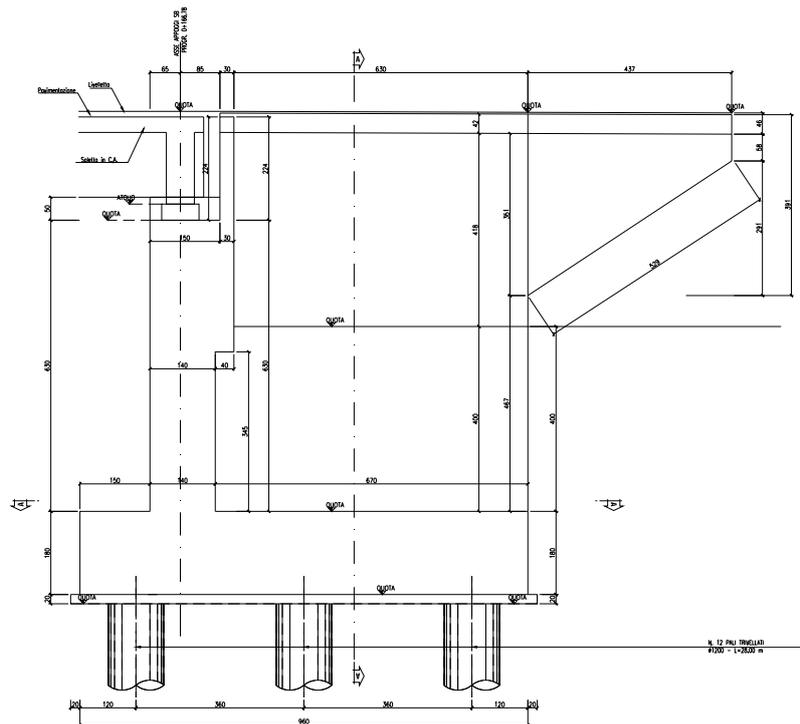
Sezione longitudinale spalla B.
